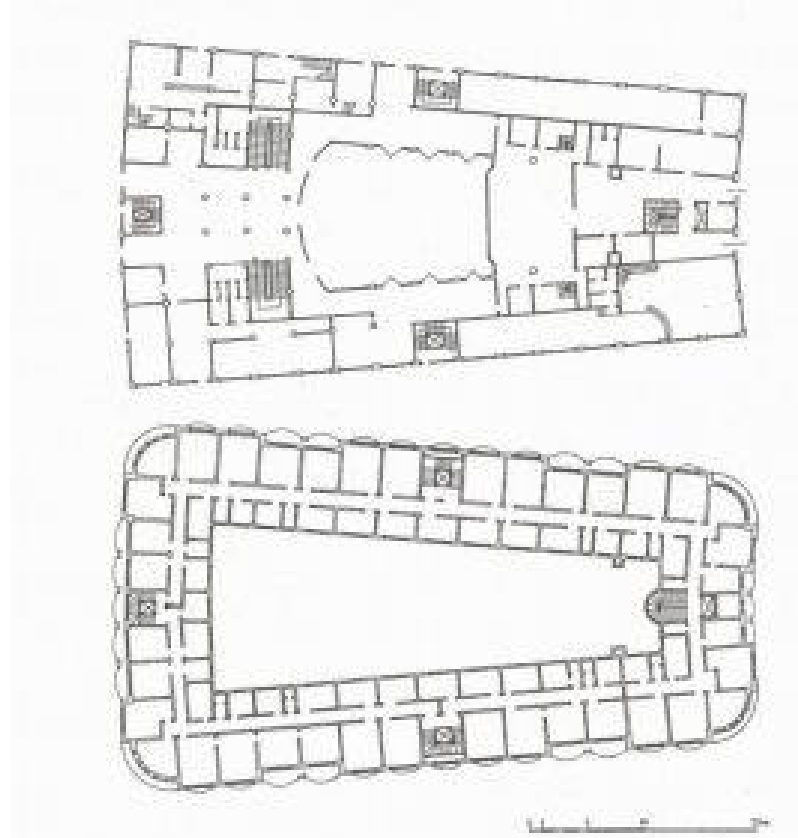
Salih Çelebi Apartmanı Planı (Aydın, 2017)
